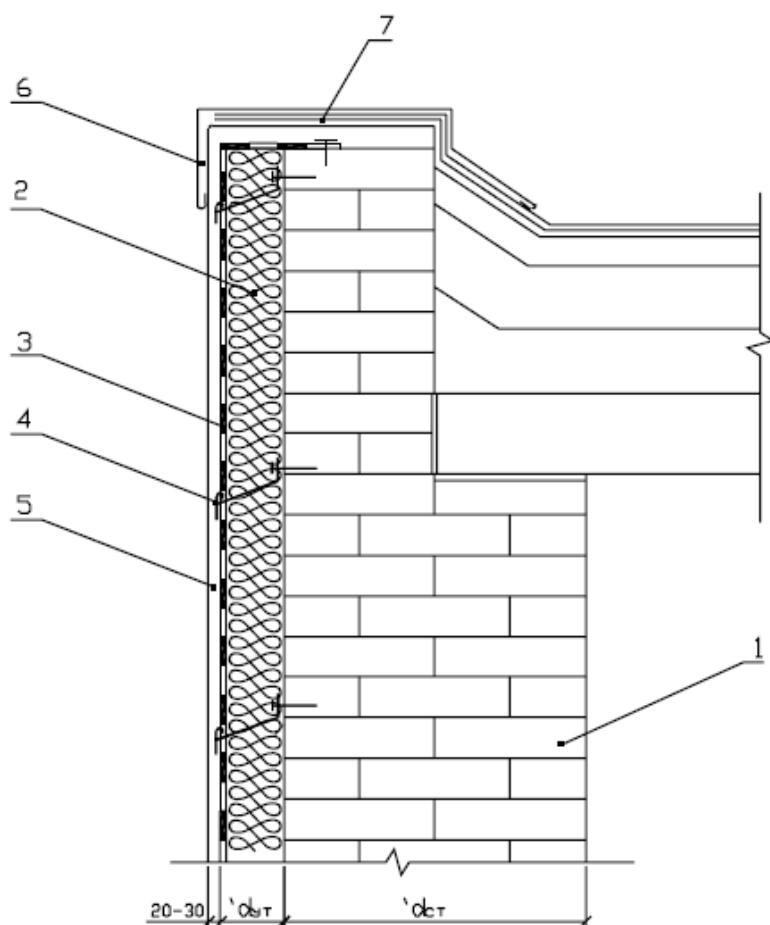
Внешний угол здания с утеплением плитами марки "ТЕРМОФАСАД" в конструкции со штукатурным покрытием и креплением подвижными анкерами
